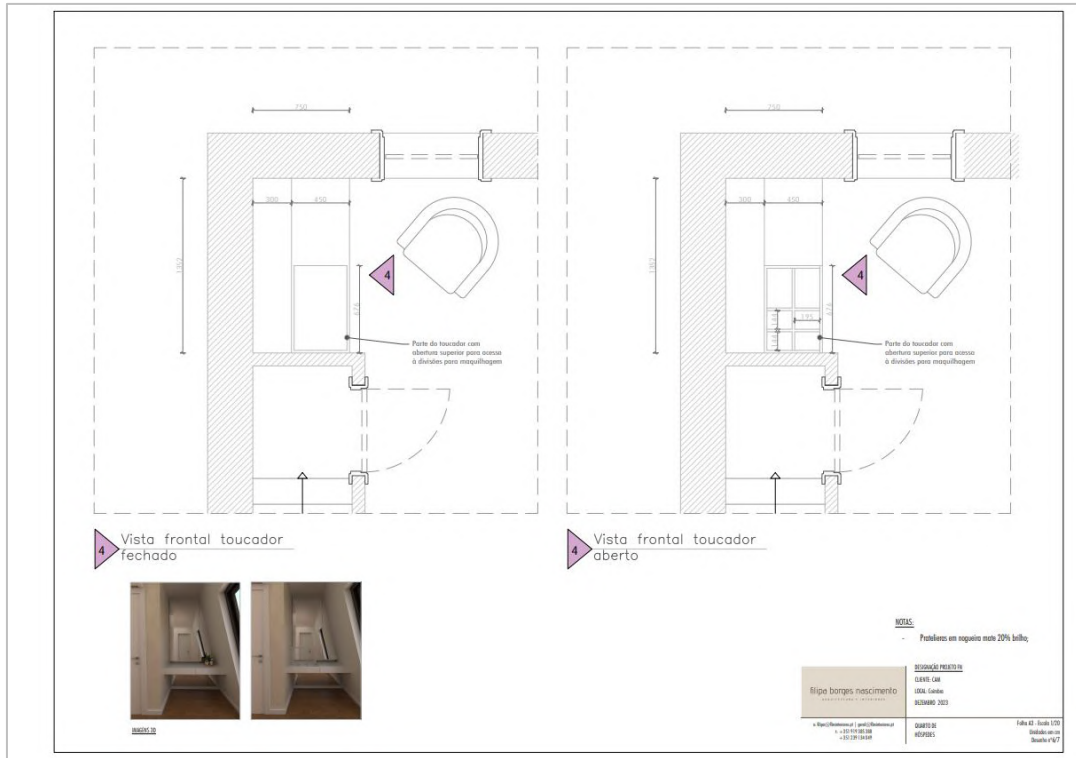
Planta baixa tucador - Projeto CM. Fonte: Autora.
